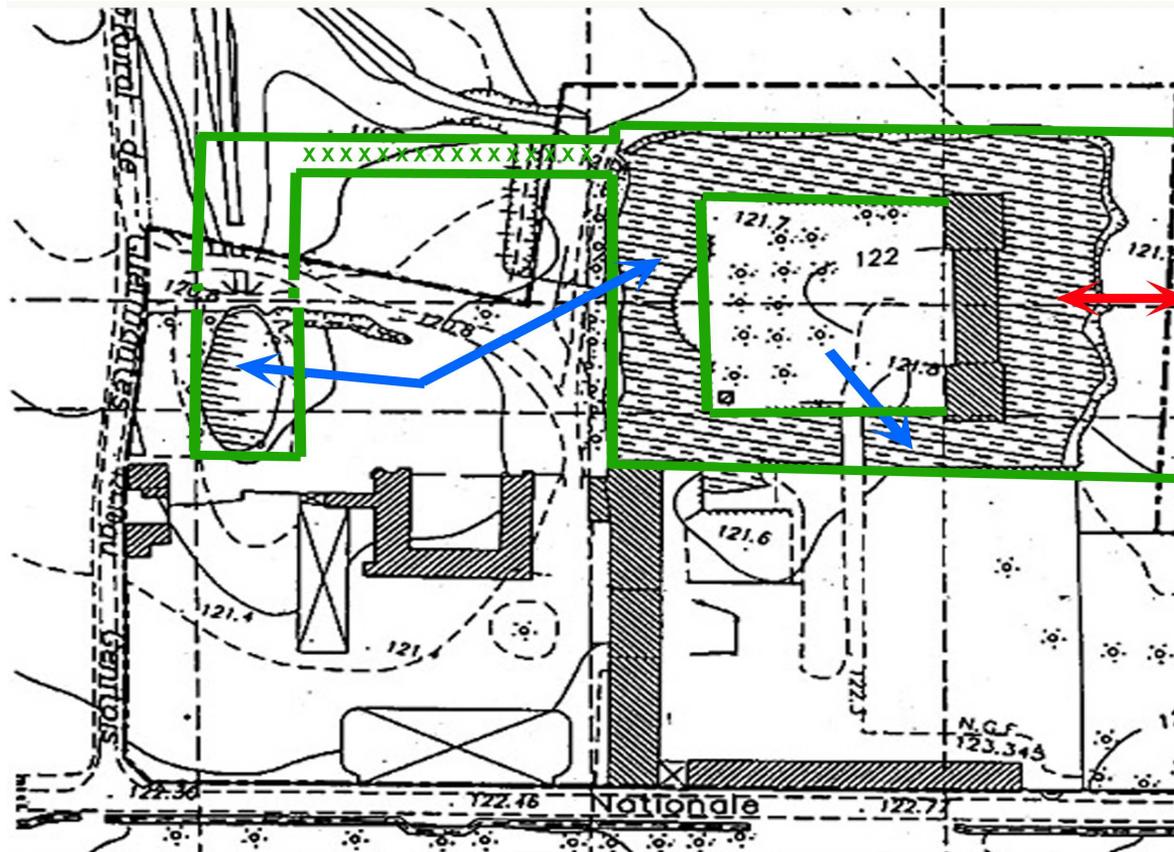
plan des barrières empêchant l'accès des amphibiens au chantier
